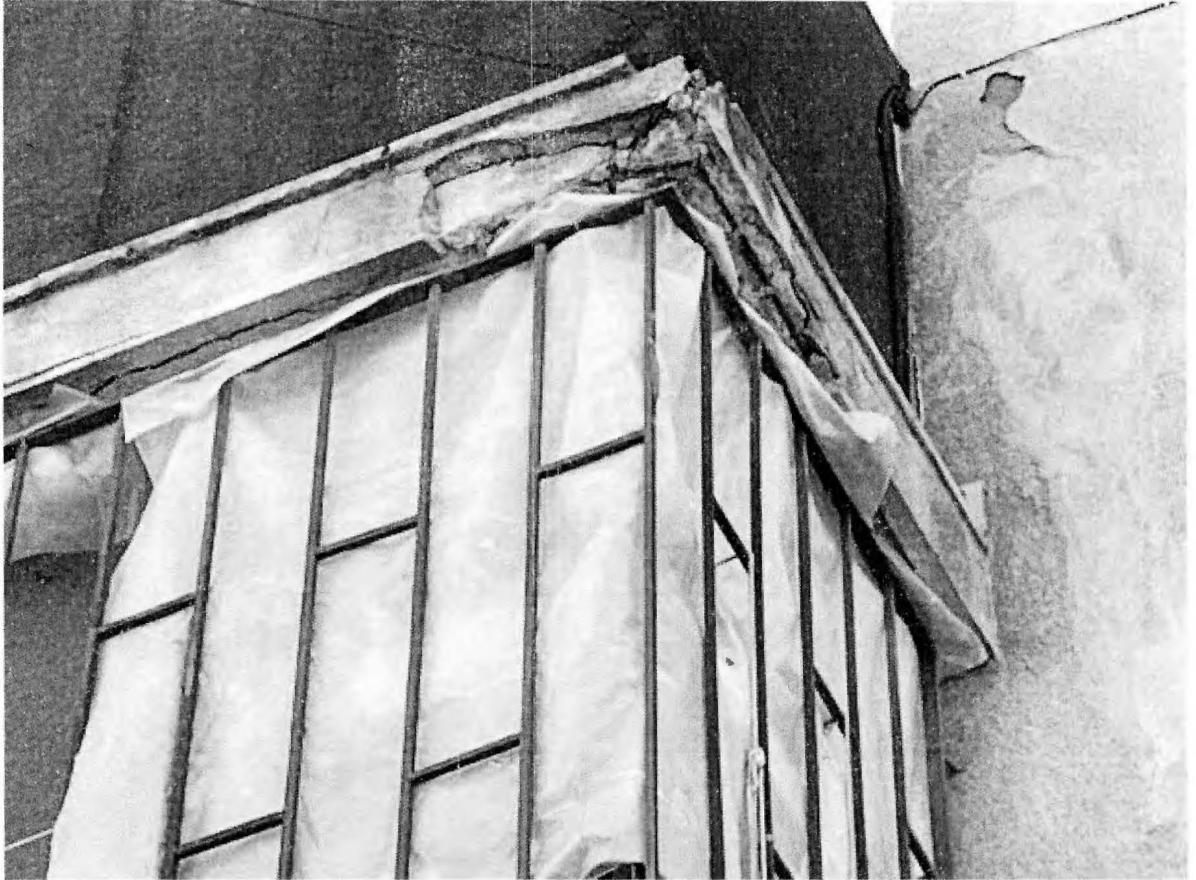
Desprendimiento de recubrimiento en losa de balcón y protecciones de ventanas con oxidación en fachada oeste.
